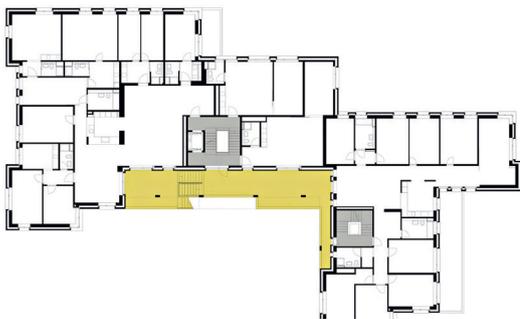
| Kraftwerk2. Grundriss 2. Obergeschoß
